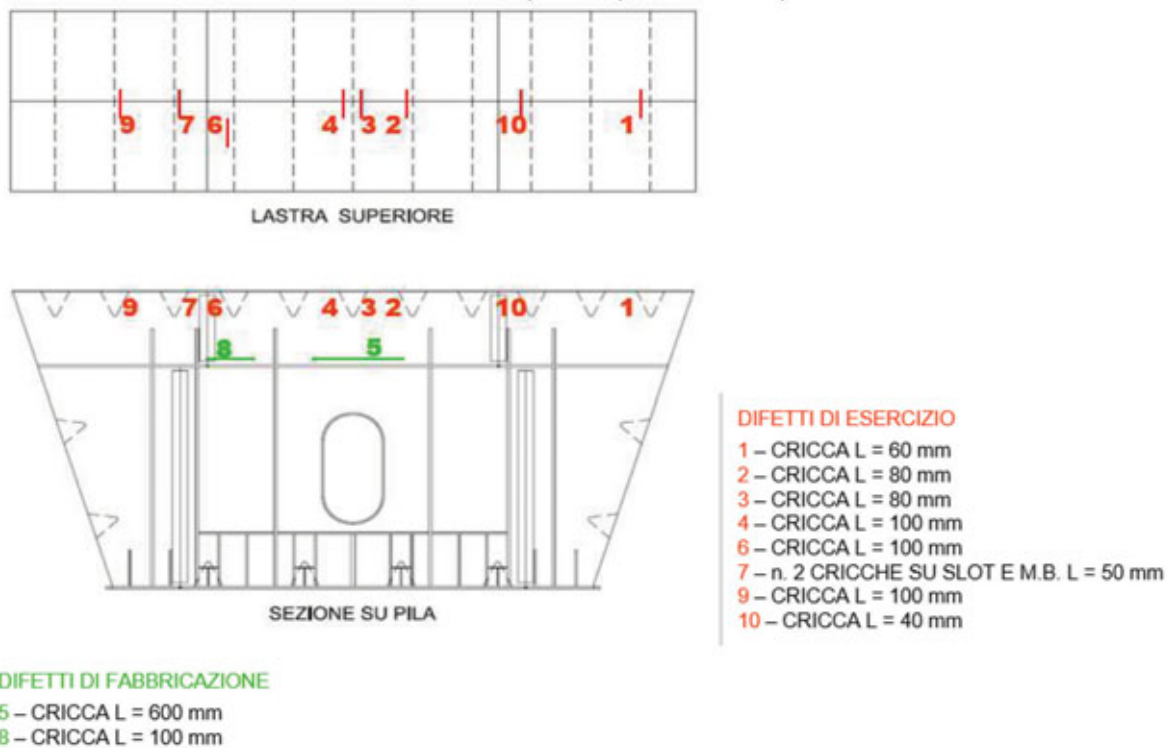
| Collocazione di rotture su sezione 13 in corrispondenza della pila 1.
